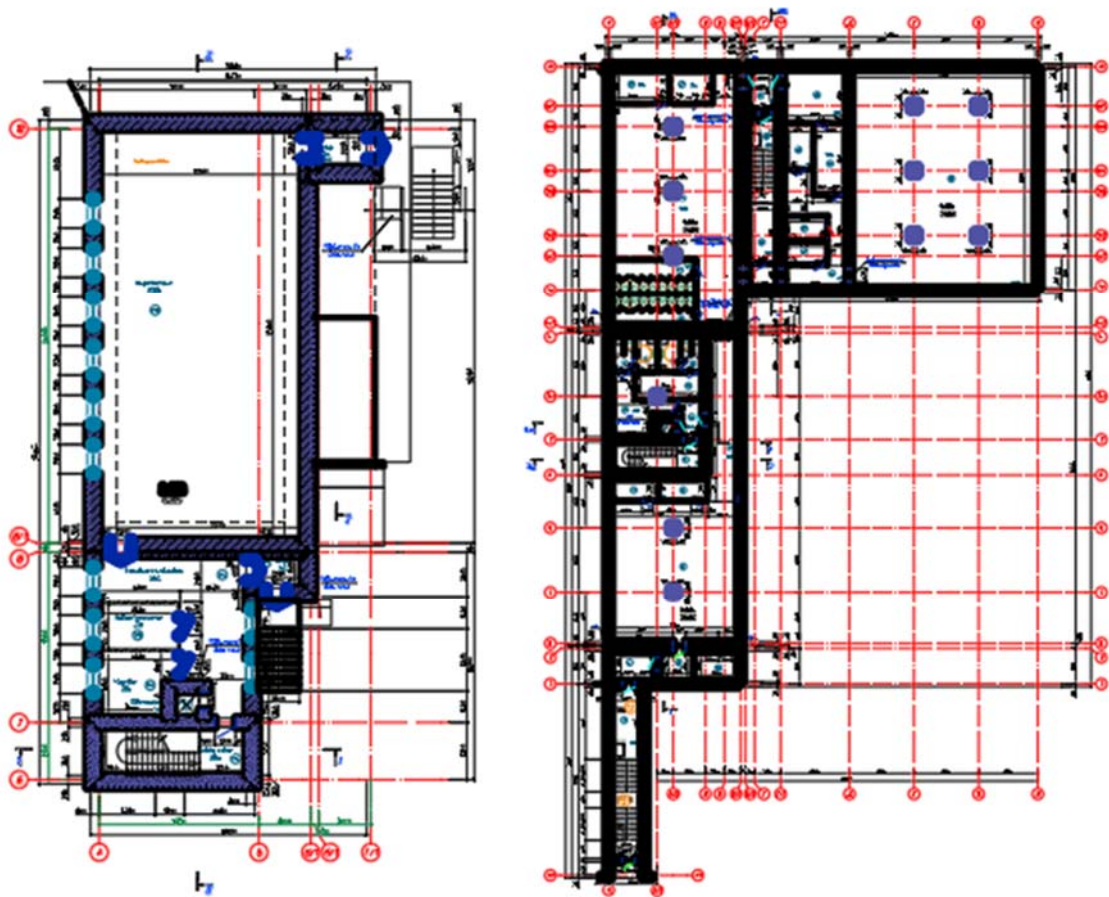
Плани будівлі спортзалу та укриття для дітей
